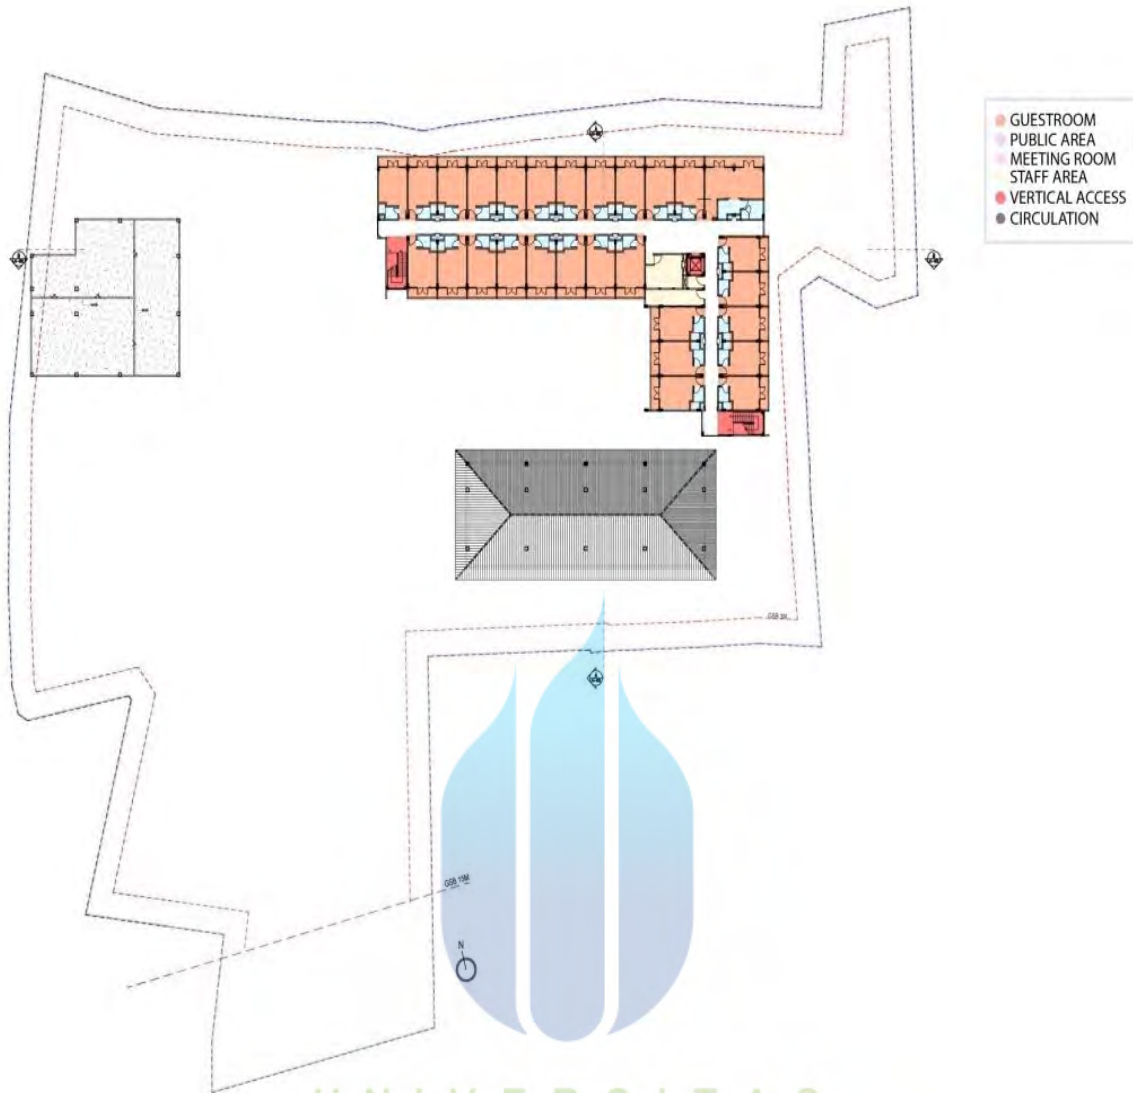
Detail Kamar - Kamar Hotel Lantai 2
